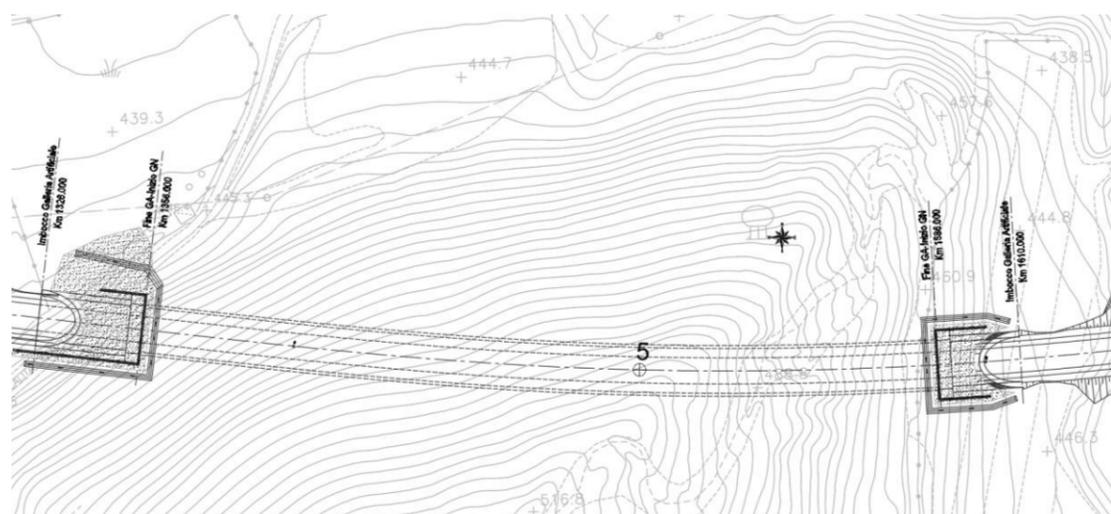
Stralcio planimetrico della galleria "Mercatello 1"
